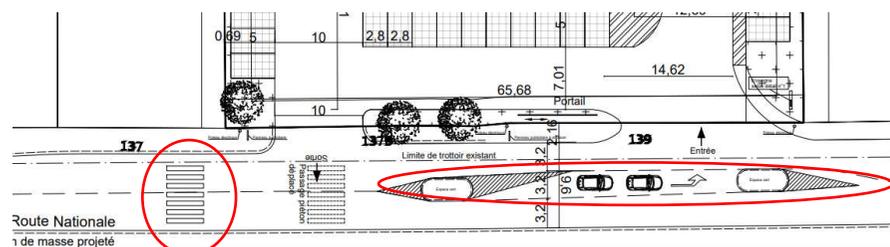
Plan masse de l'accès au projet – Source : Aldi
